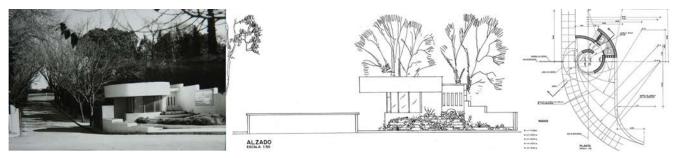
Acceso principal y garita de control: alzado y planta del control de entrada, (Archivo del ITCC nº 29204 y tubo II-47).
